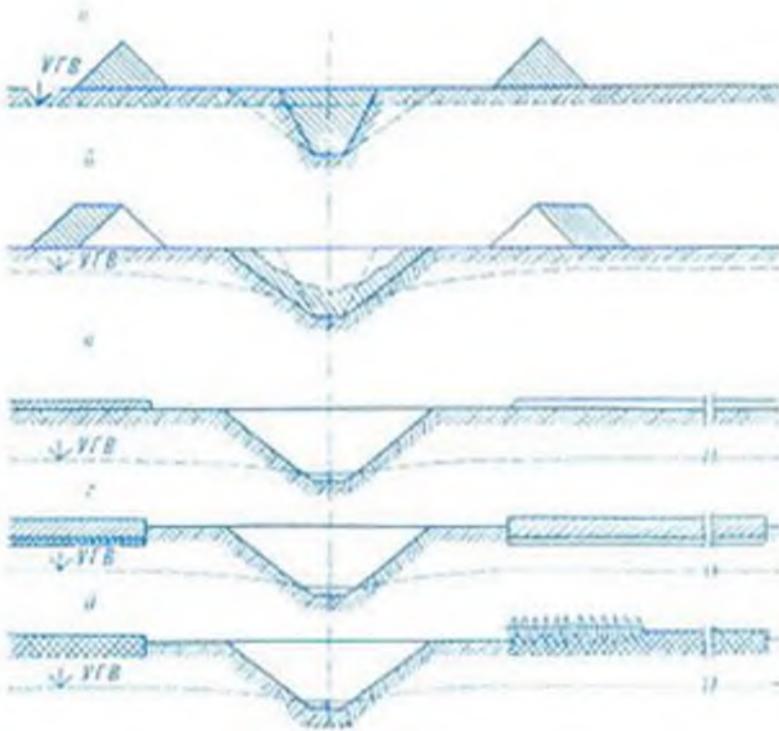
Строительство каналов. Технологические схемы производства земляных работ по созданию открытых осушительных каналов в неустойчивых грунтах с запашкой минерального грунта выемки под пахотный слой: а — разработка грунта и пионерном канале-траншее; б — доработка сечения канала до проектных размеров после понижения уровня грунтовых вод; в — разравнивание грунта из временных кавальеров слоем 0,1 м; г — вспашка полозом на глубину не менее 0,3 м с полным оборотом пласта; д — разделка пласта дисковыми боронами (дискование).
